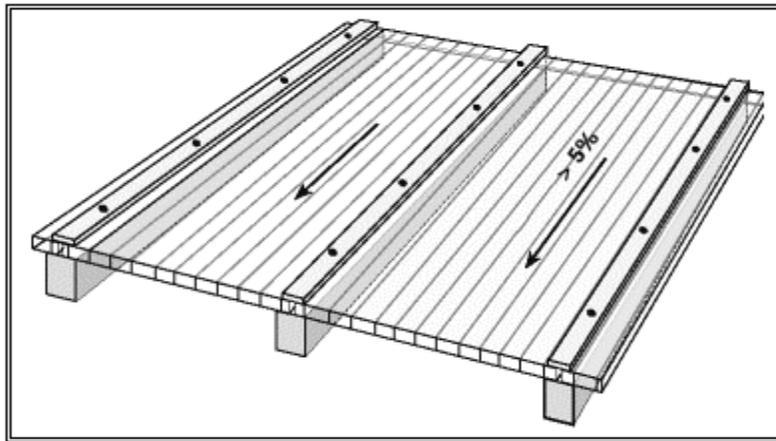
Inclinación mínima para placas instaladas en posición horizontal.
